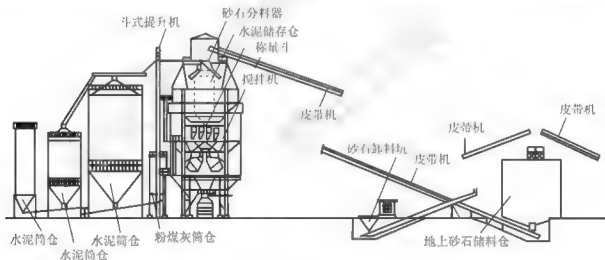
大型混凝土集中搅拌站竖向布置示意图
